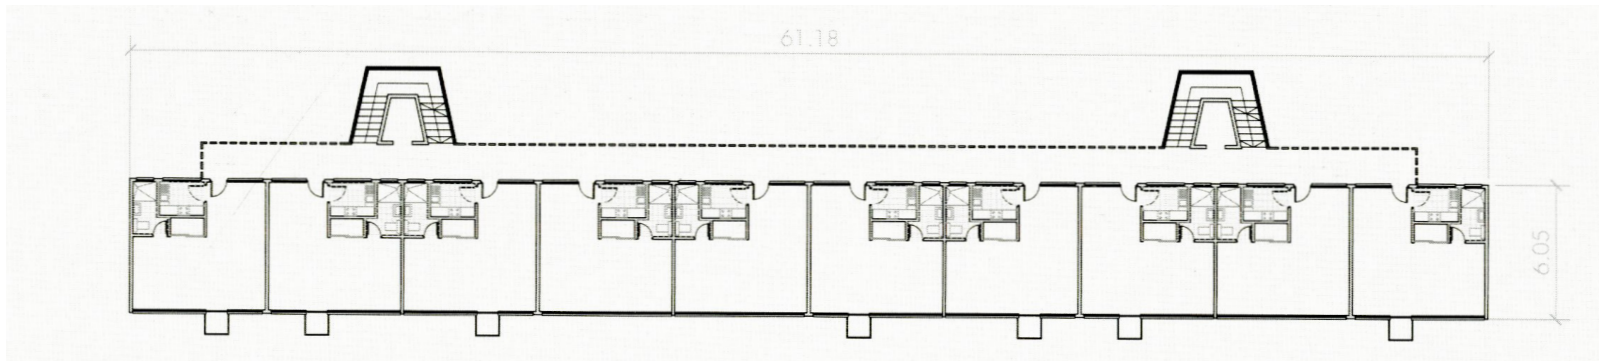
\_Planta Baja. Conjunto habitacional Santa Fe.
